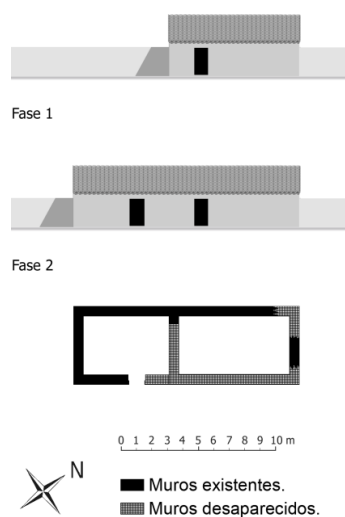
Alzados y planta de las primeras Fases de *Can Pereta*.
